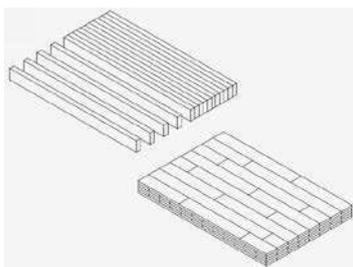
Brettstapeldecke und Brettsperrholzdecke [56]
